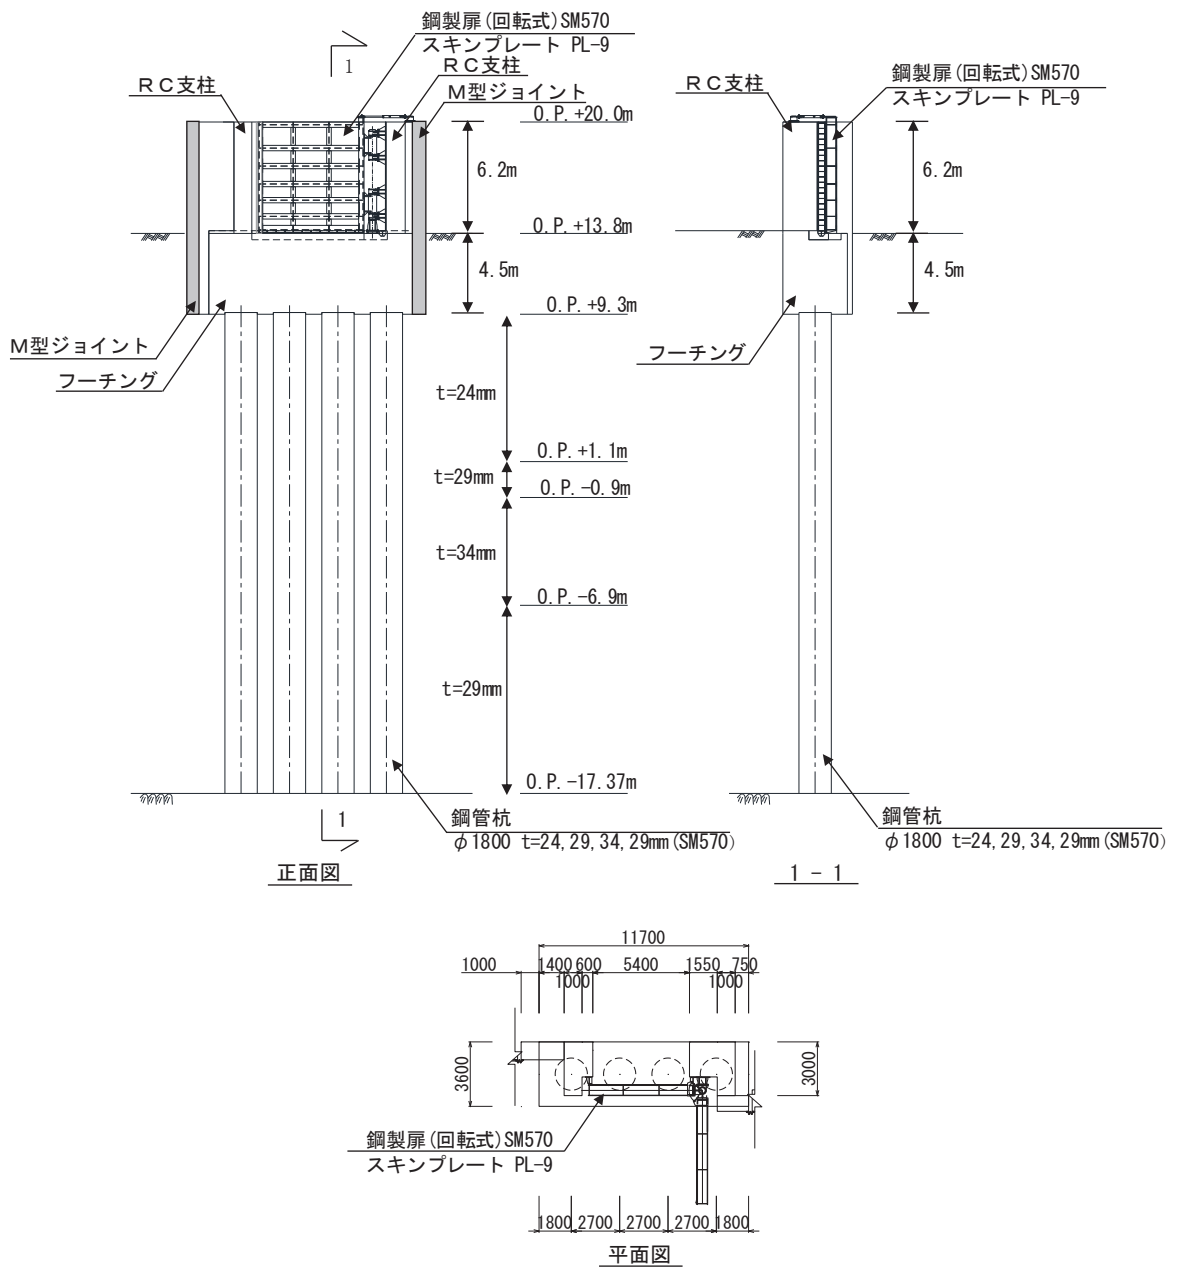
(1) 鋼製扉 3 の構造図 (正面図及び断面図, 平面図)
